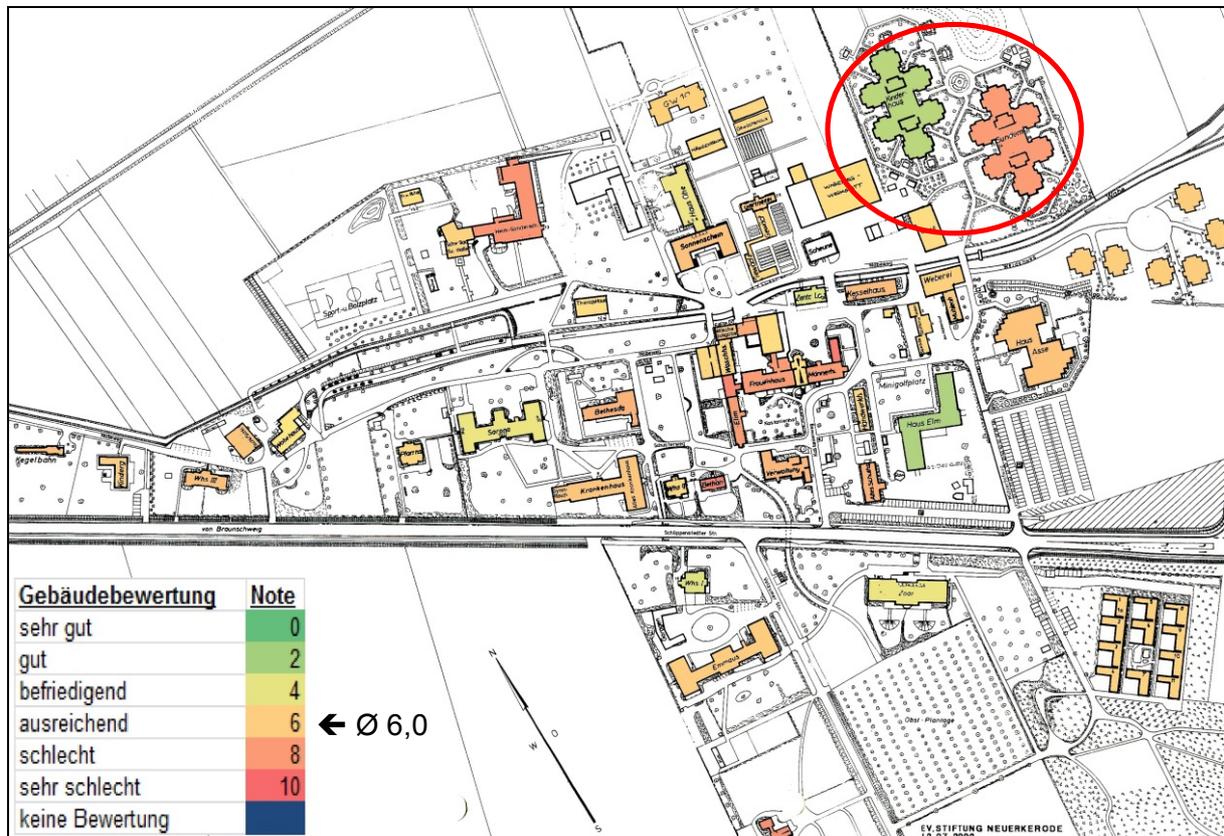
Lageplan NE - Elektroinstallation und Beleuchtung
